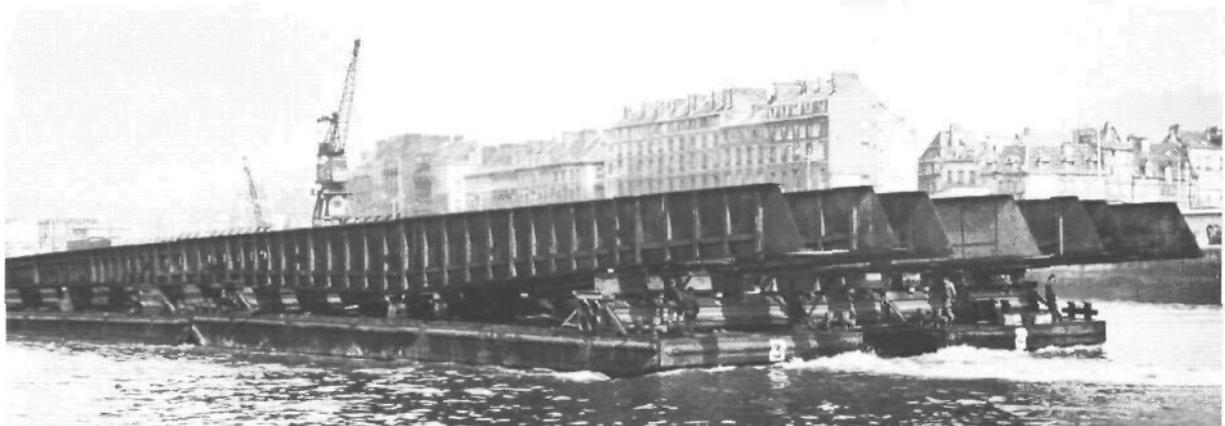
Transport fluvial - Convoi de 630 tonnes et 78 mètres de longueur.
